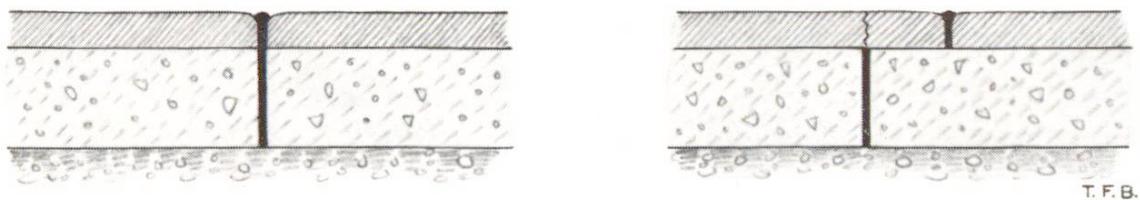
Correspondance des joints entre le revêtement et la couche de fondation.
